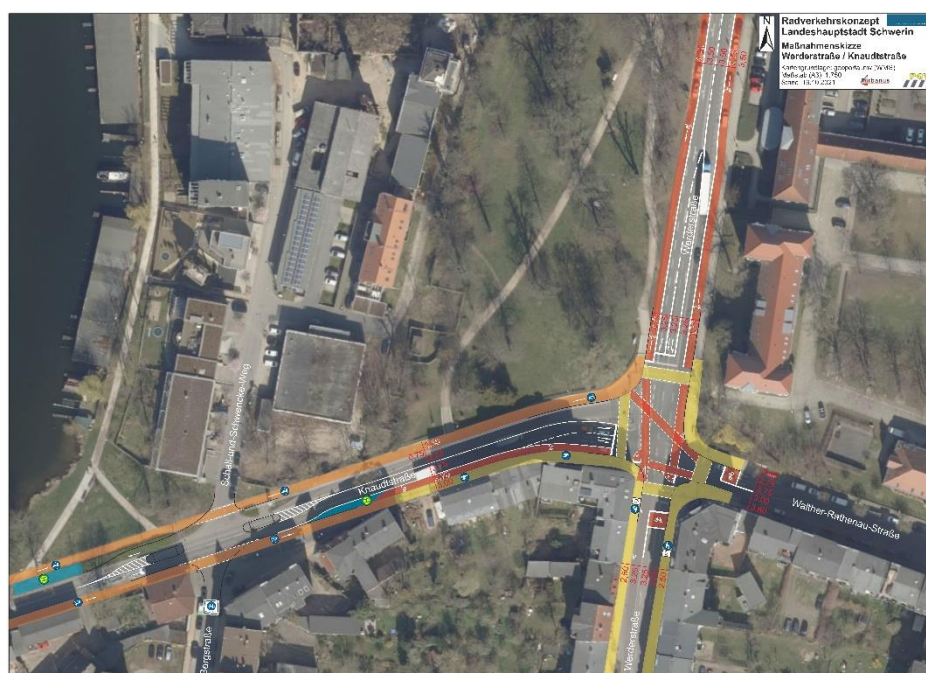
Lösungsskizze Knotenpunktbereich Werderstraße / Knaudtstraße / Bergstraße
